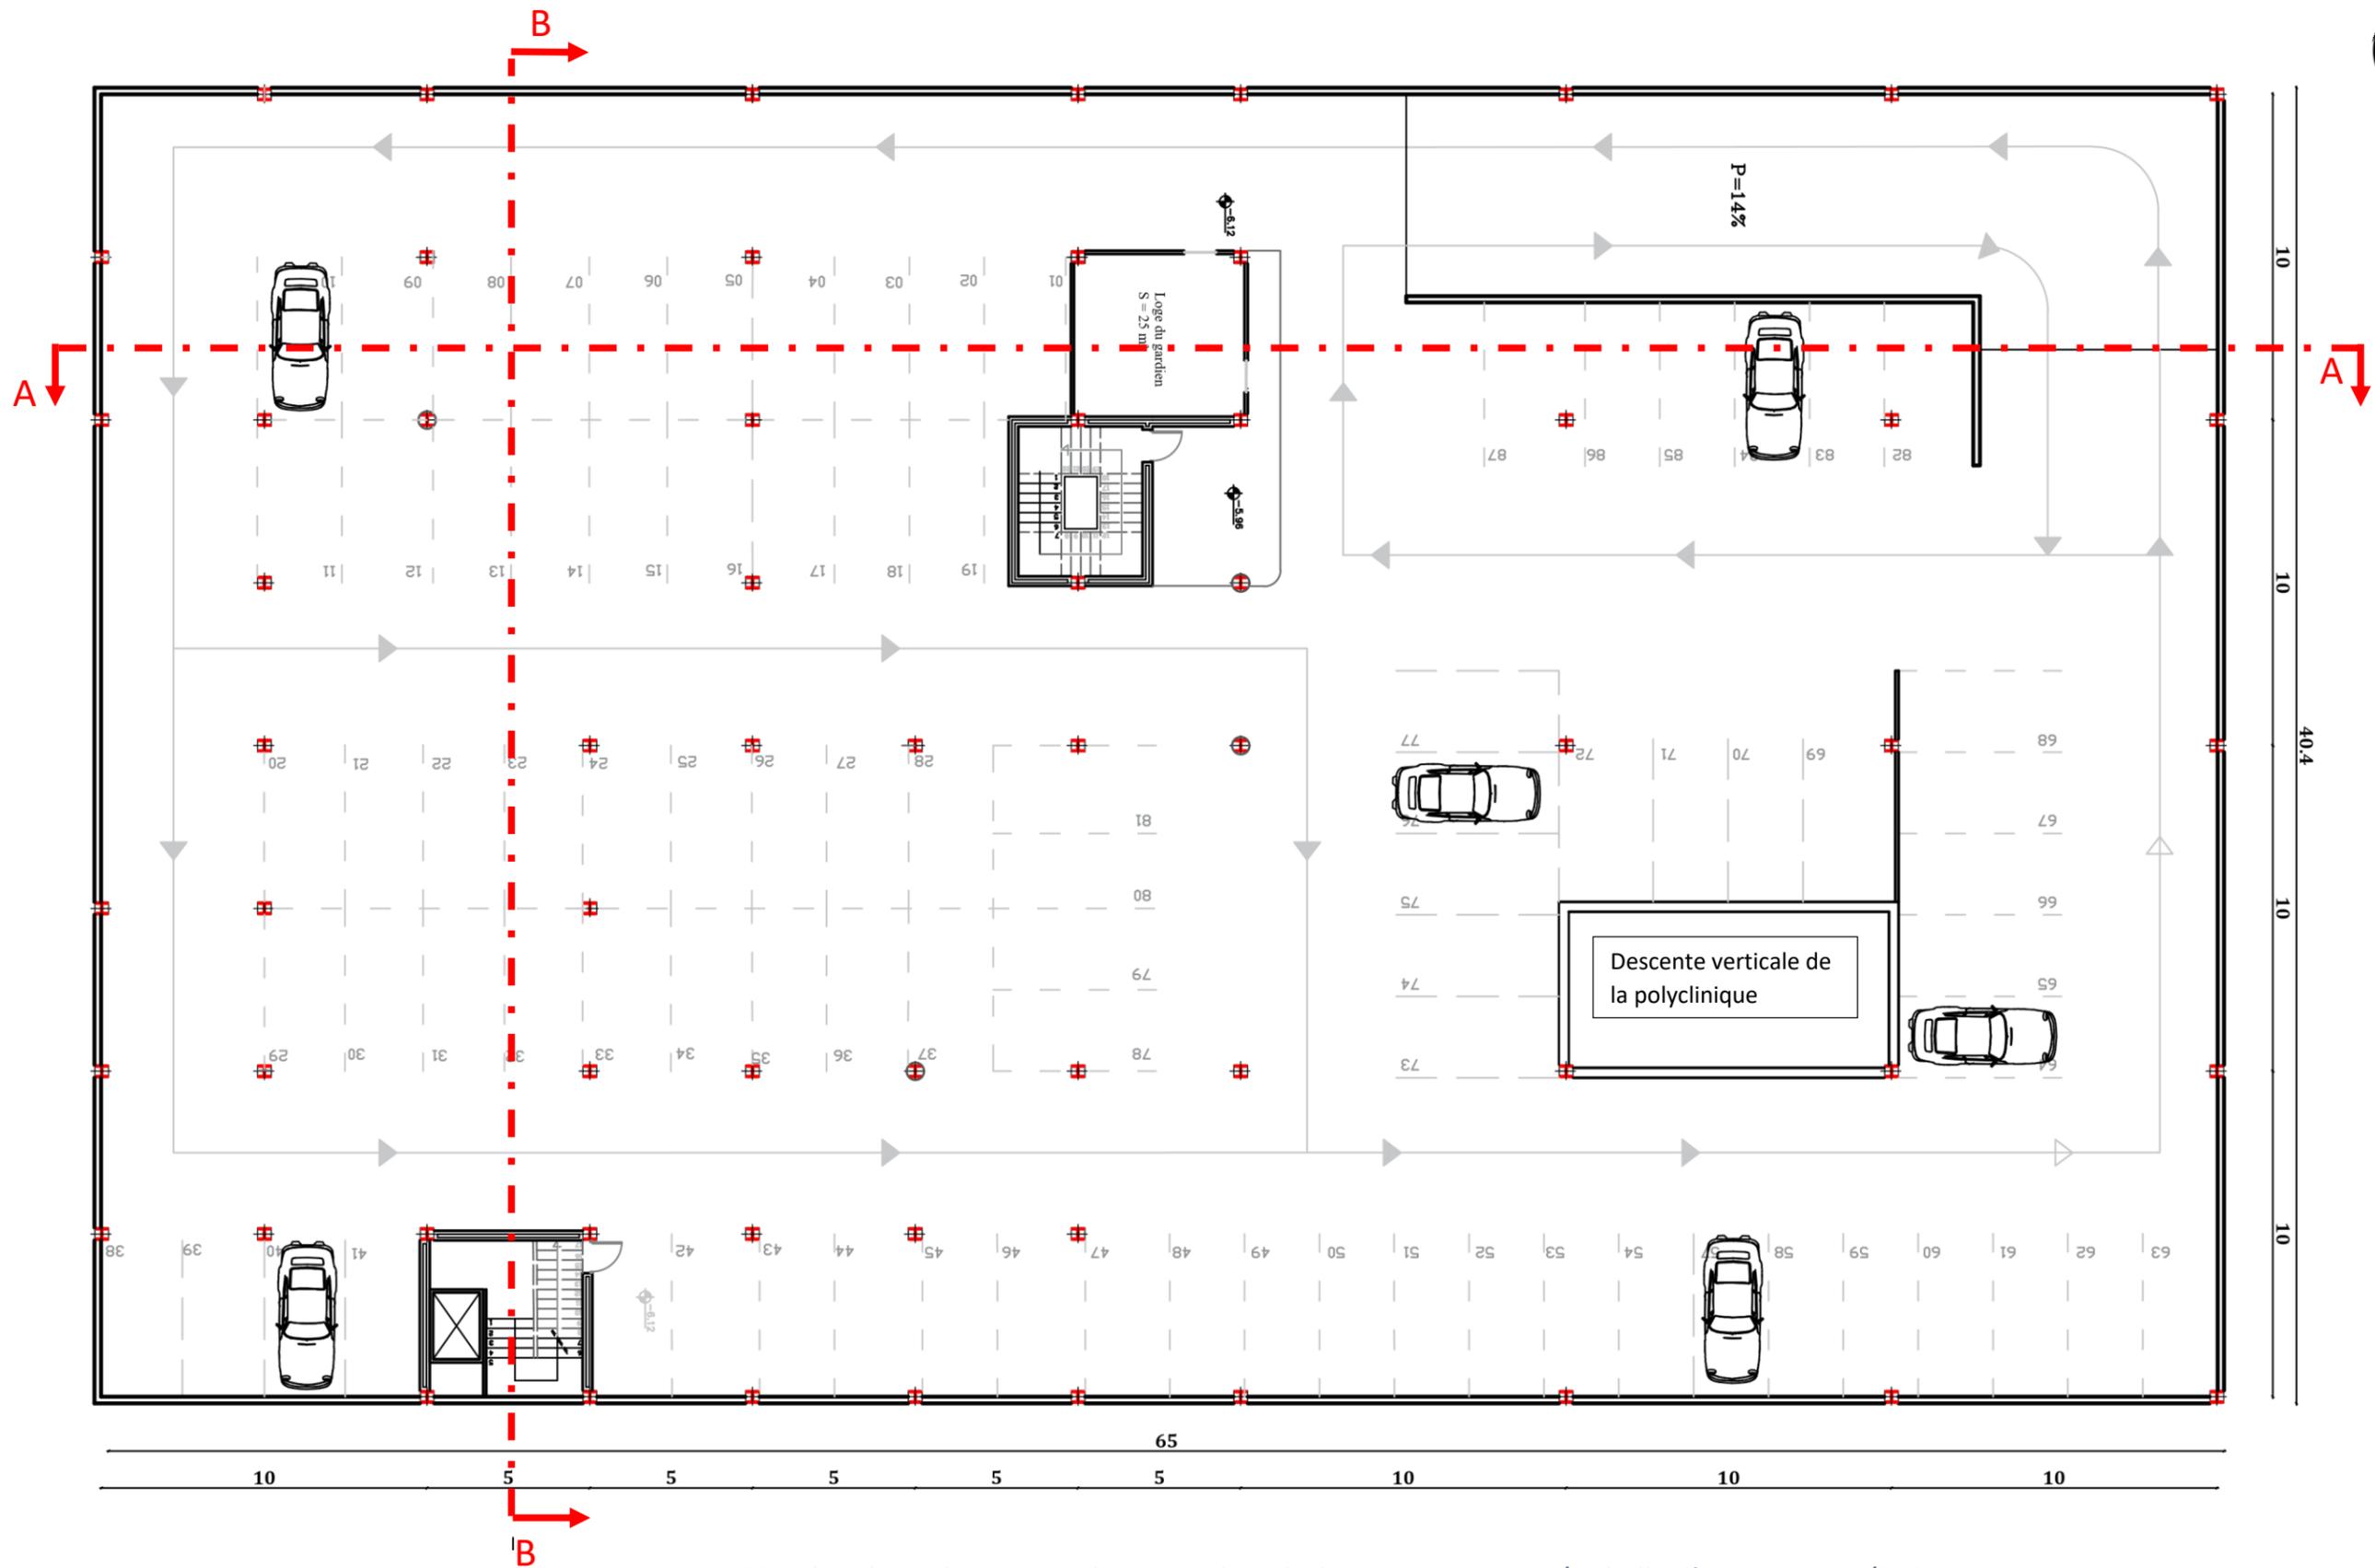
Plan du parking mutualiser avec la polyclinique : niveau -2 / Echelle d'impression 1/200
